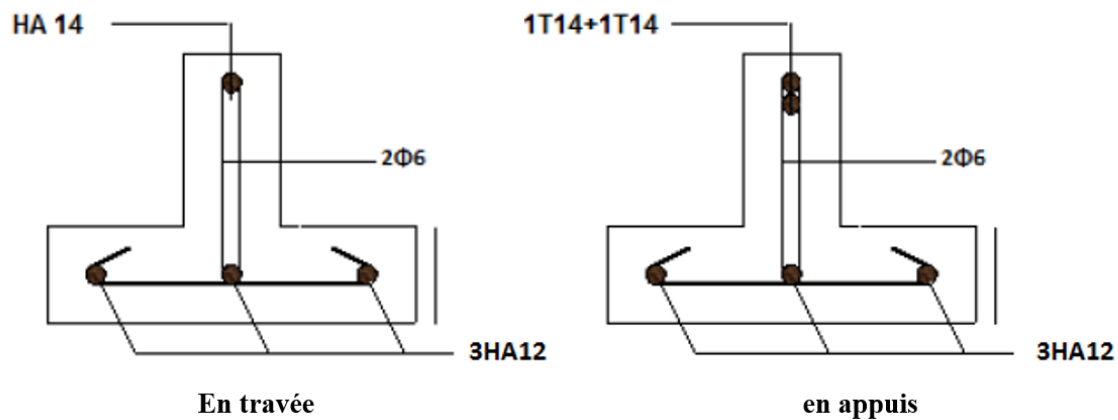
Disposition des armatures dans la poutrelle type 2 (appuis et travée)
